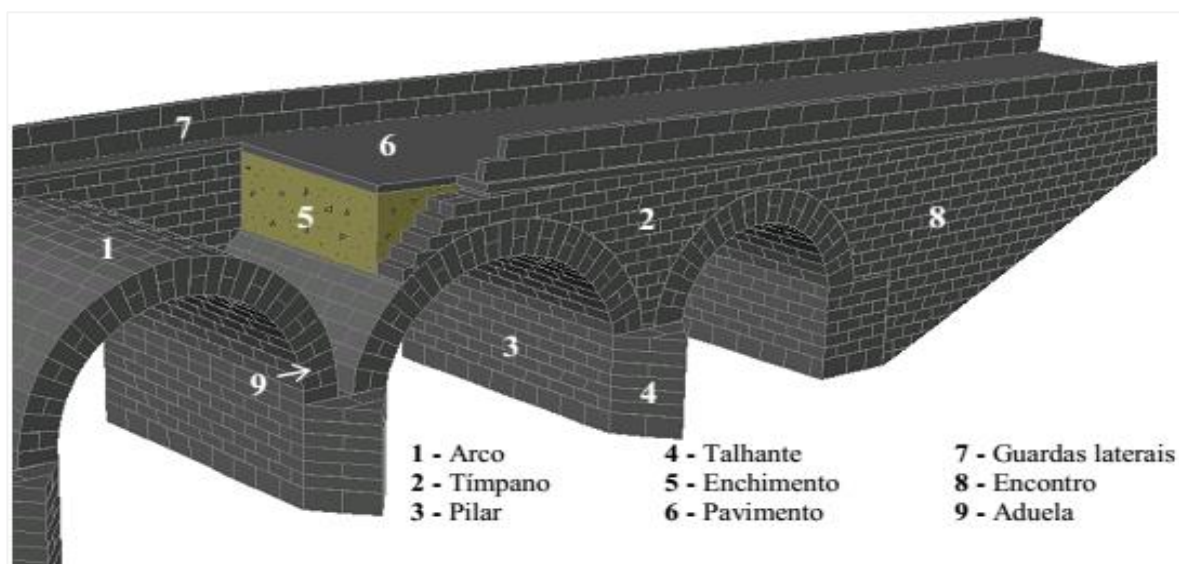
Esquema da constituição dos elementos das pontes de alvenaria de pedra [3];
